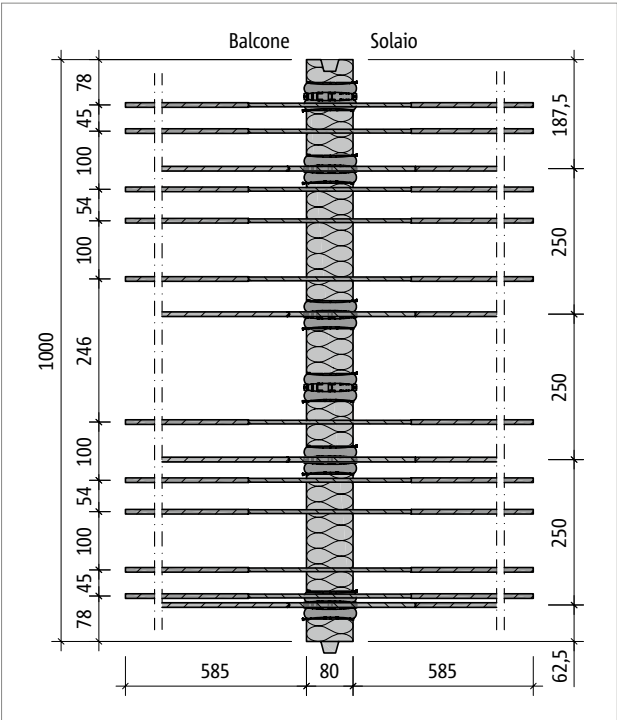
Schöck Isokorb® T tipo KL-M4-V1: pianta del prodotto
